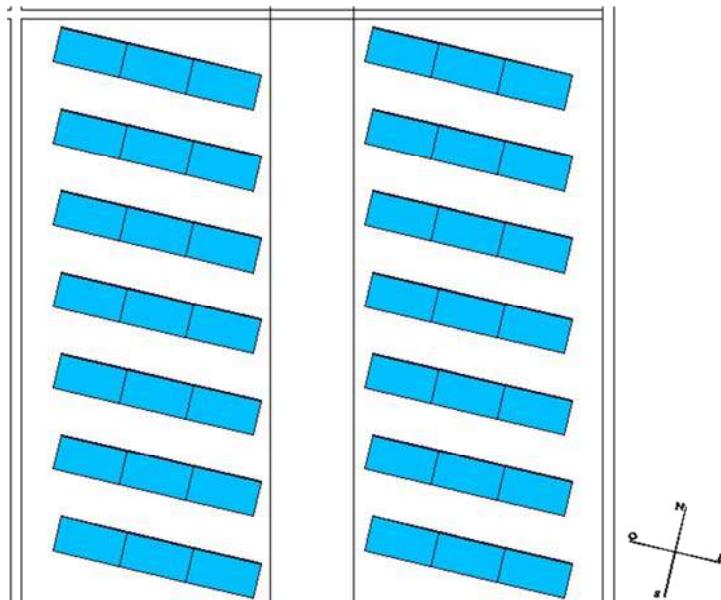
Distribución paneles sobre cubierta Cochera.
